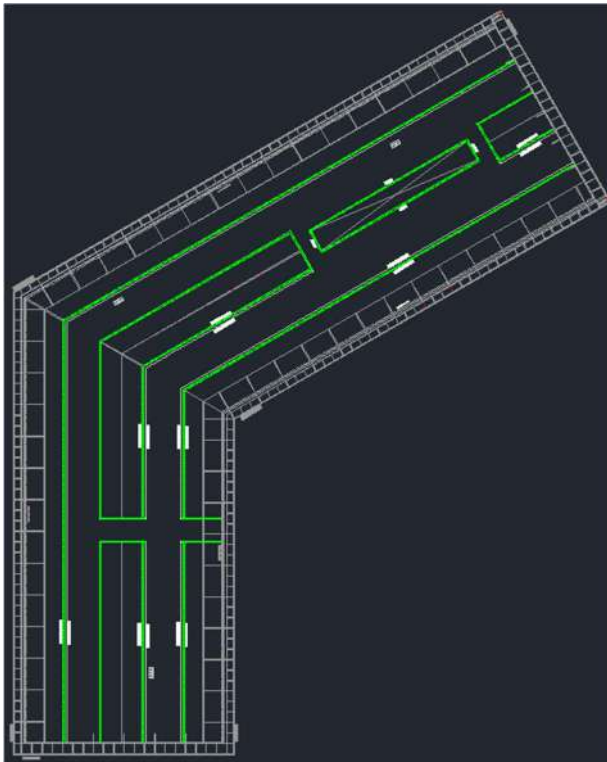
Alvenaria cobertura – Planta baixa Bloco B
